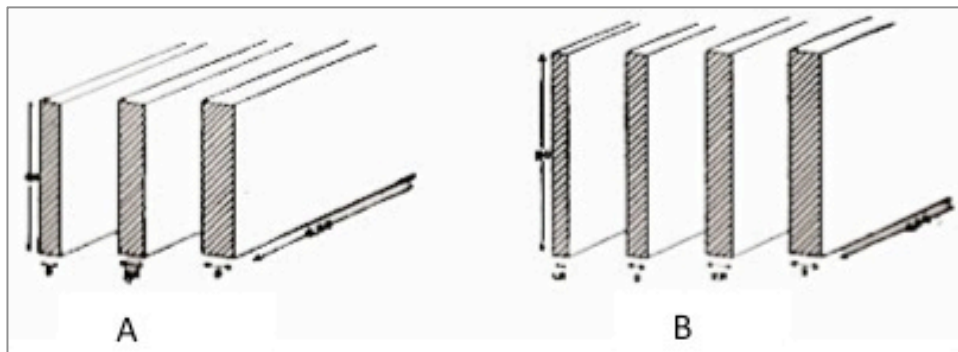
A - Guias ; B - Tábuas de junta seca. Fonte: PIANCA (1980)
